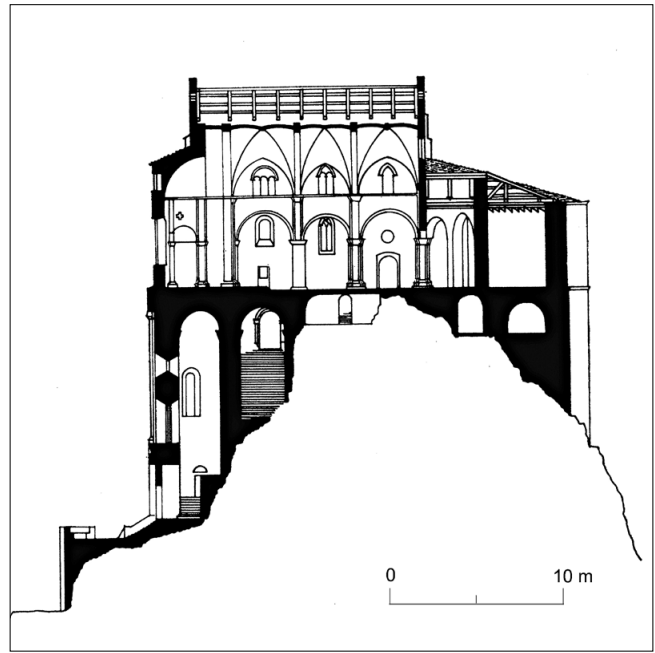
Sacra di San Michele, sezione longitudinale del basamento e della chiesa (foto archivio autore).
